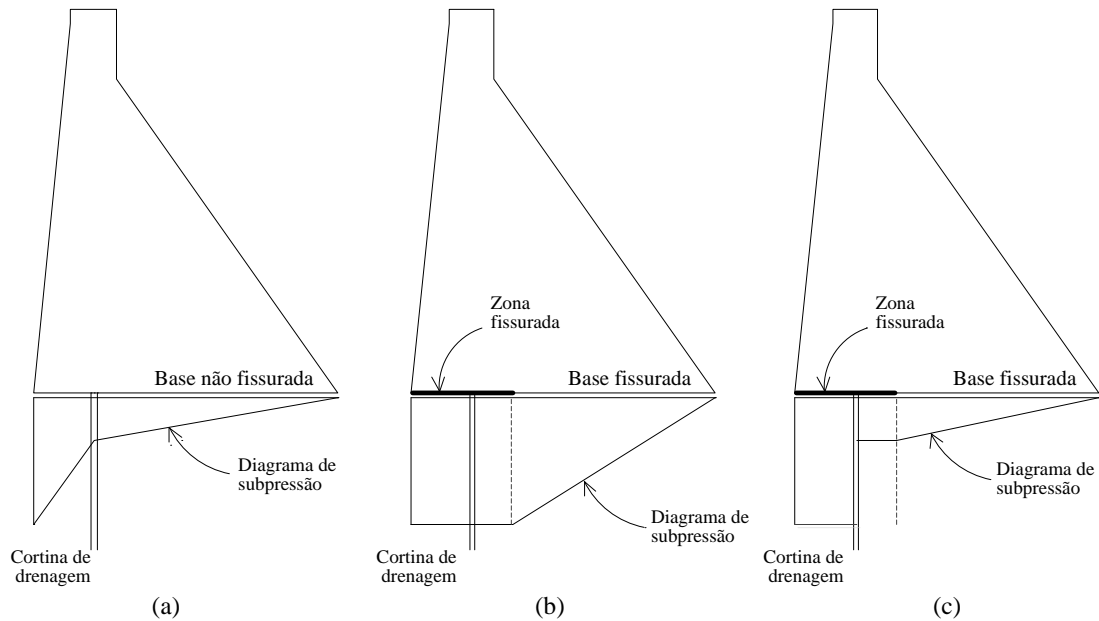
Diagrama de subpressão para a secção não fissurada (a), para a secção fissurada com danos extensos no sistema de drenagem (b) e para a secção fissurada com danos parciais no sistema de drenagem (c)
